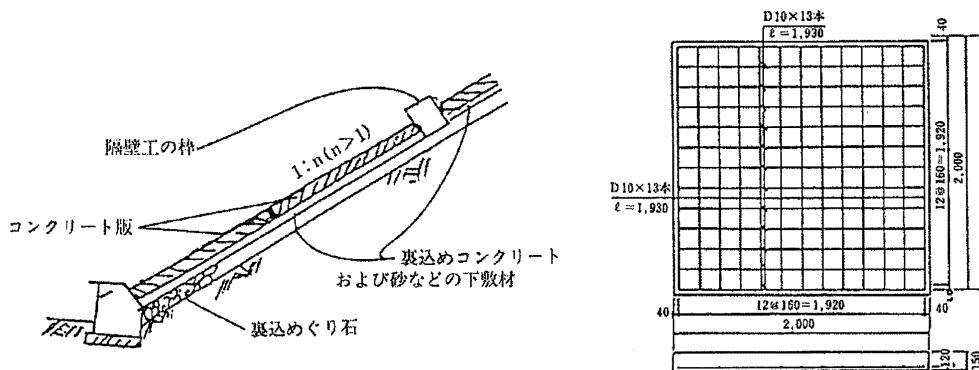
コンクリート版張工の施工断面例とコンクリート版の一例
